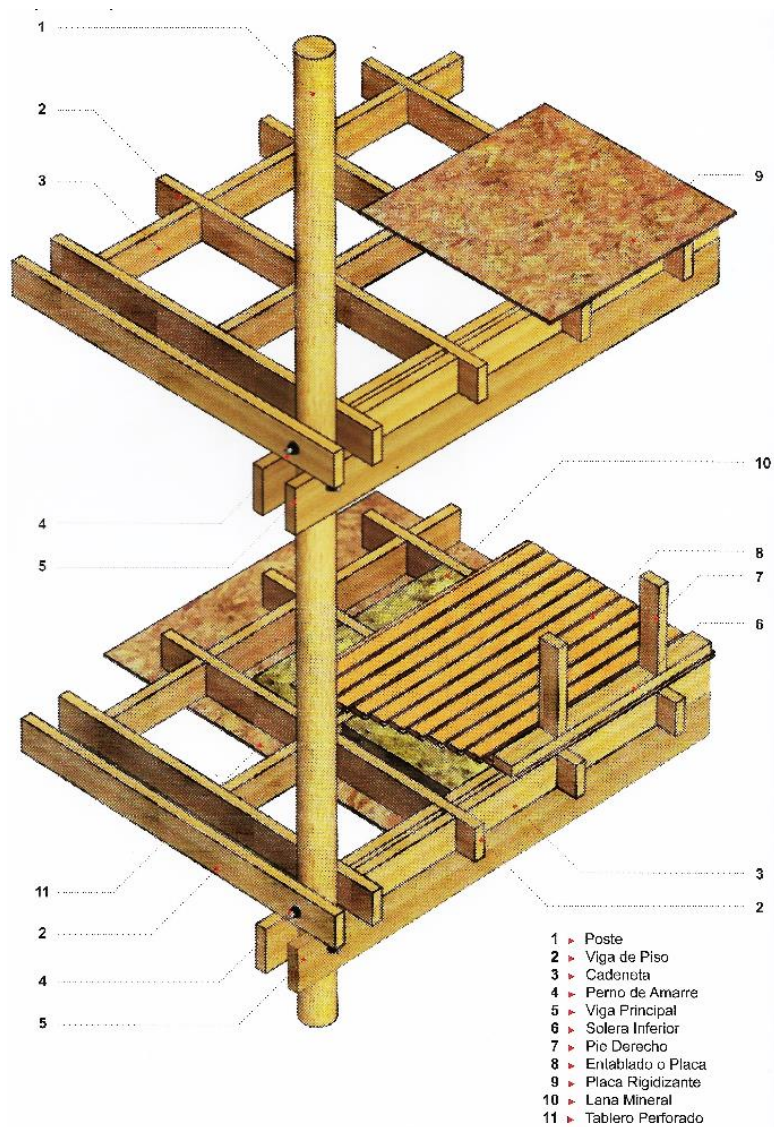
Sistema Constructivo Post and Beam. Entramados de Madera, Universidad del Bio Bio, Chile.
